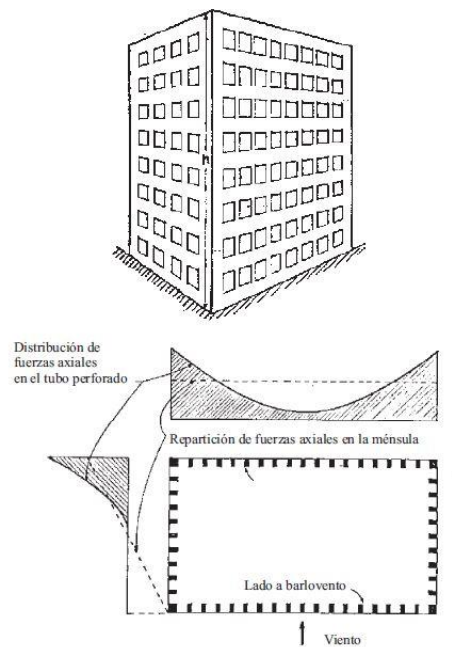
Tubo Estructural. (a) Estructura del edificio (b) Distribución de fuerzas en columnas
